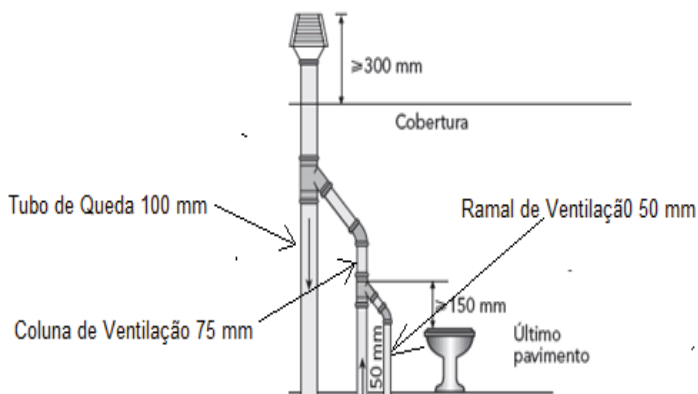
Detalhe da ventilação primária (ligação da ventilação no último pavimento)
